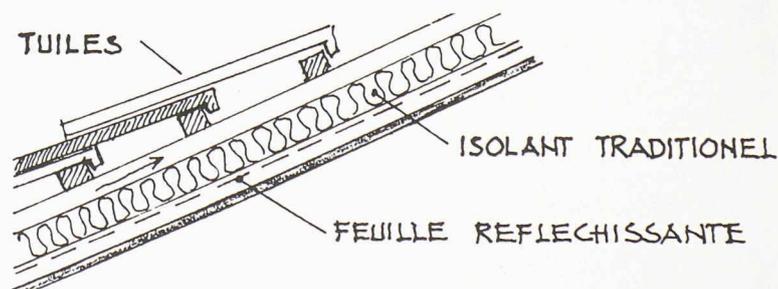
Une feuille réfléchissante est parfois appliquée sur la face interne de la couche calorifuge d'un pan de toit incliné. Il vaudrait mieux la poser sur la face externe pour diminuer la surchauffe en été.
